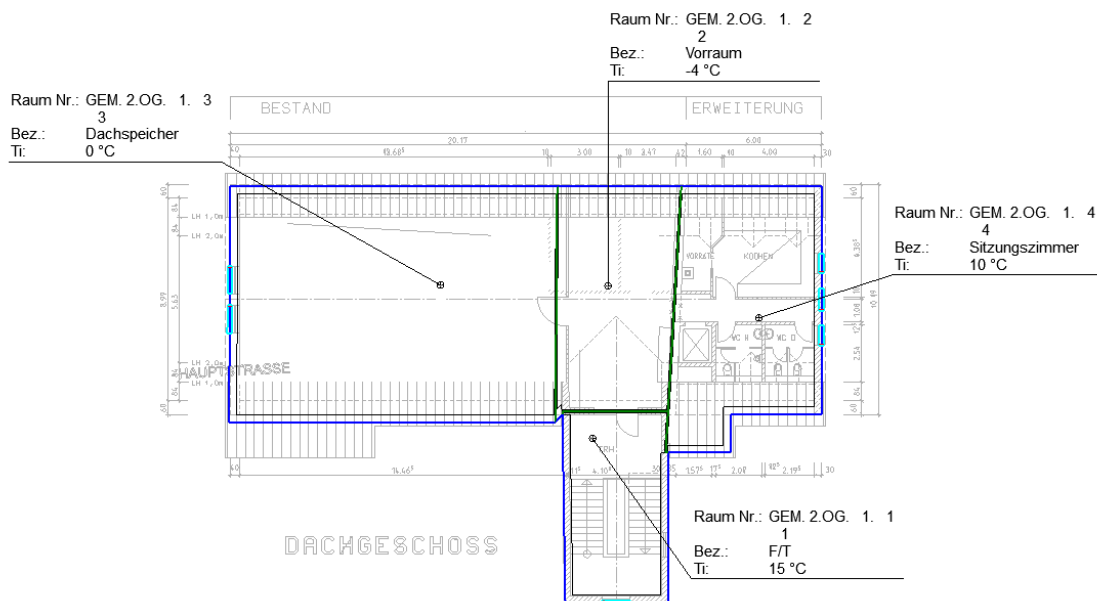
Plan Dachgeschoss Gemeindehaus (erstellt mit mh-Software)
